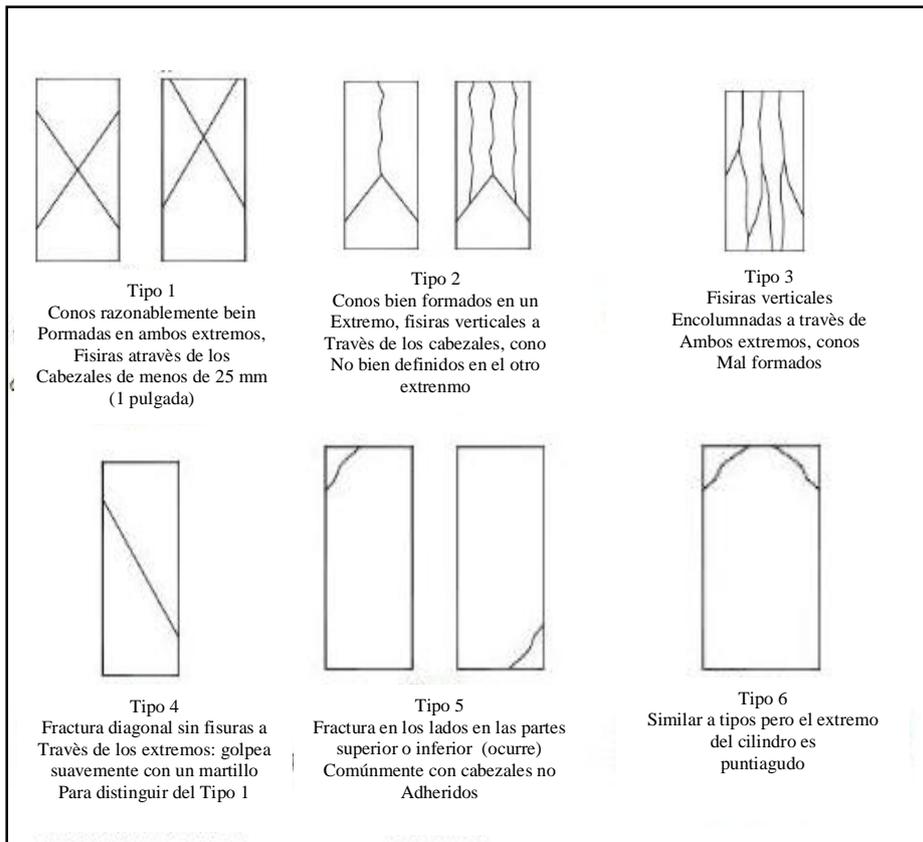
Descripción de fracturas de probetas a la compresión. Fuente: Elaboración propia
